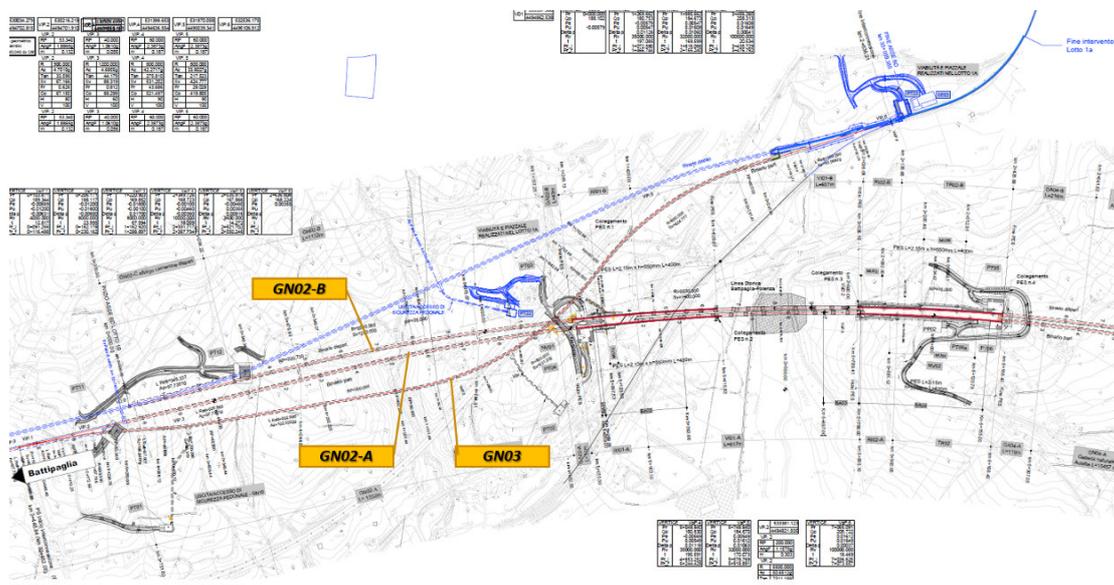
Planimetria di progetto da km 3+750 a km 6+188
